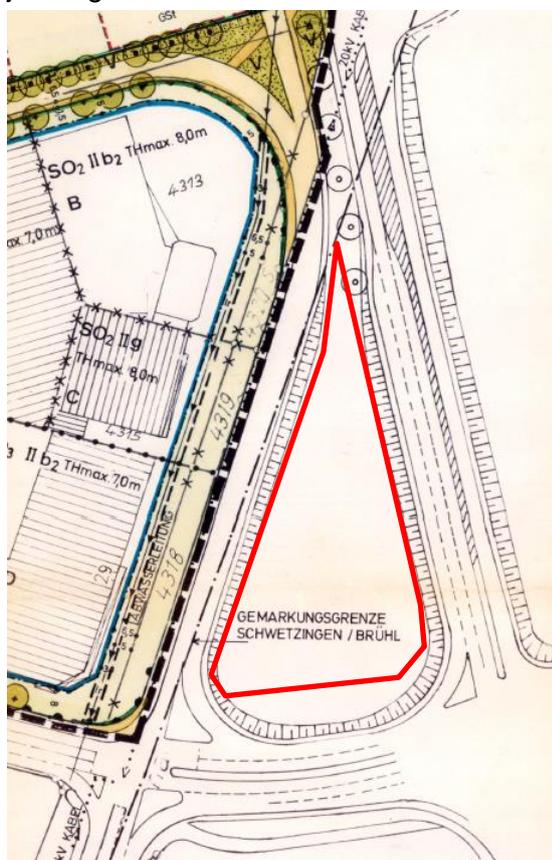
Plangrundstück und Bebauungspläne in direkter Umgebung (Quelle: Kartengrundlage Bebauungspläne Gemeinde Brühl, eigene Eintragung MVV Regioplan, 2024).
